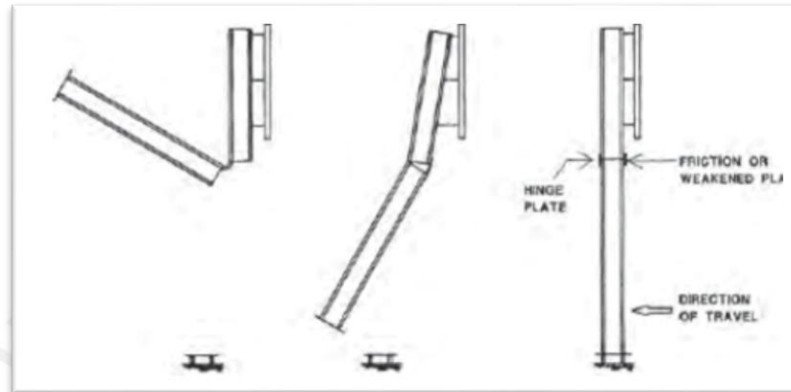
Mecanismo del elemento traspasable (izquierda a derecha)
